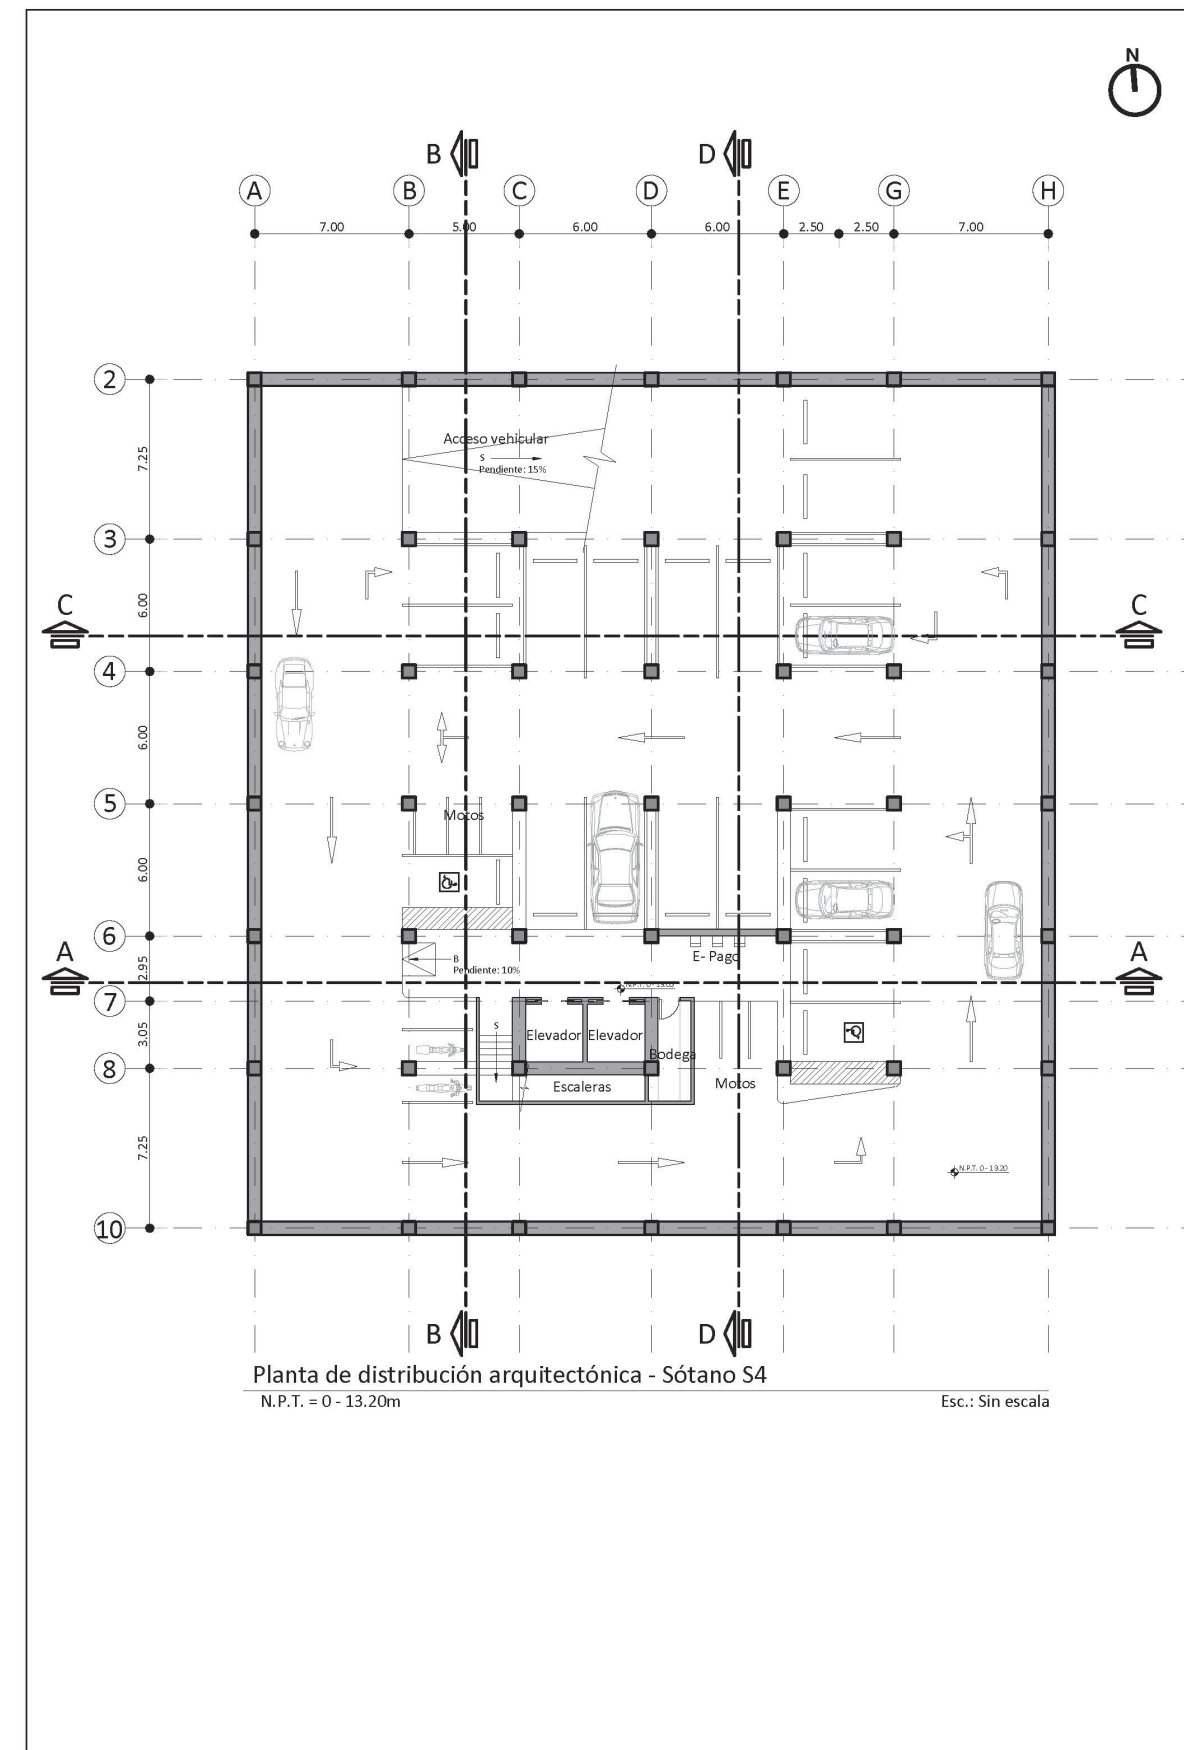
Planta de distribución arquitectónica de sótano 4. Fuente: Propia.
